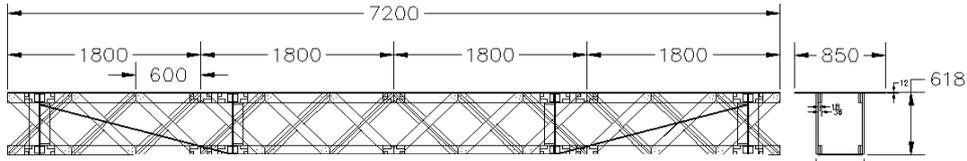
クロスウェブ橋側面図と断面図(単位: mm)
